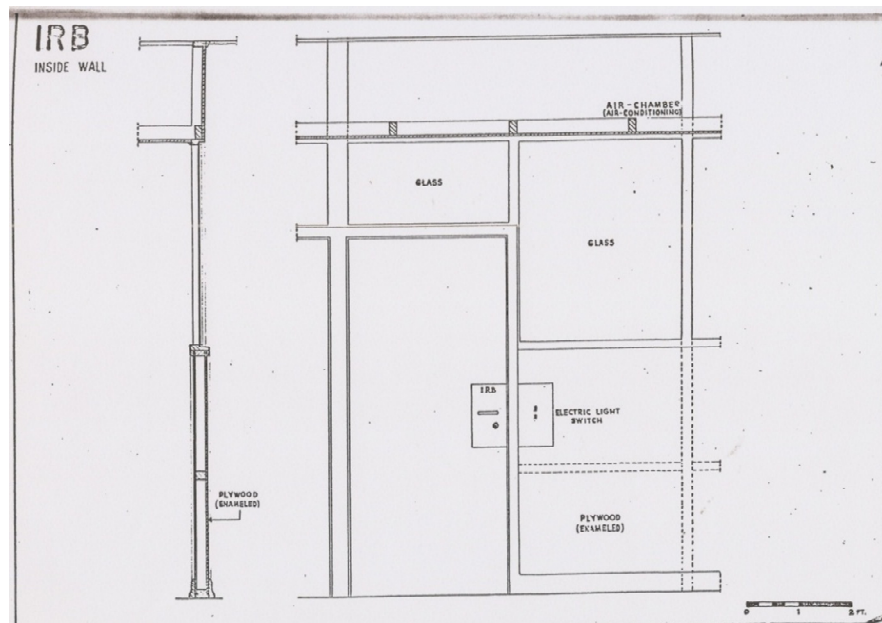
Q – Detalhamento das divisórias e de elemento de proteção para maçanetas e interruptores
